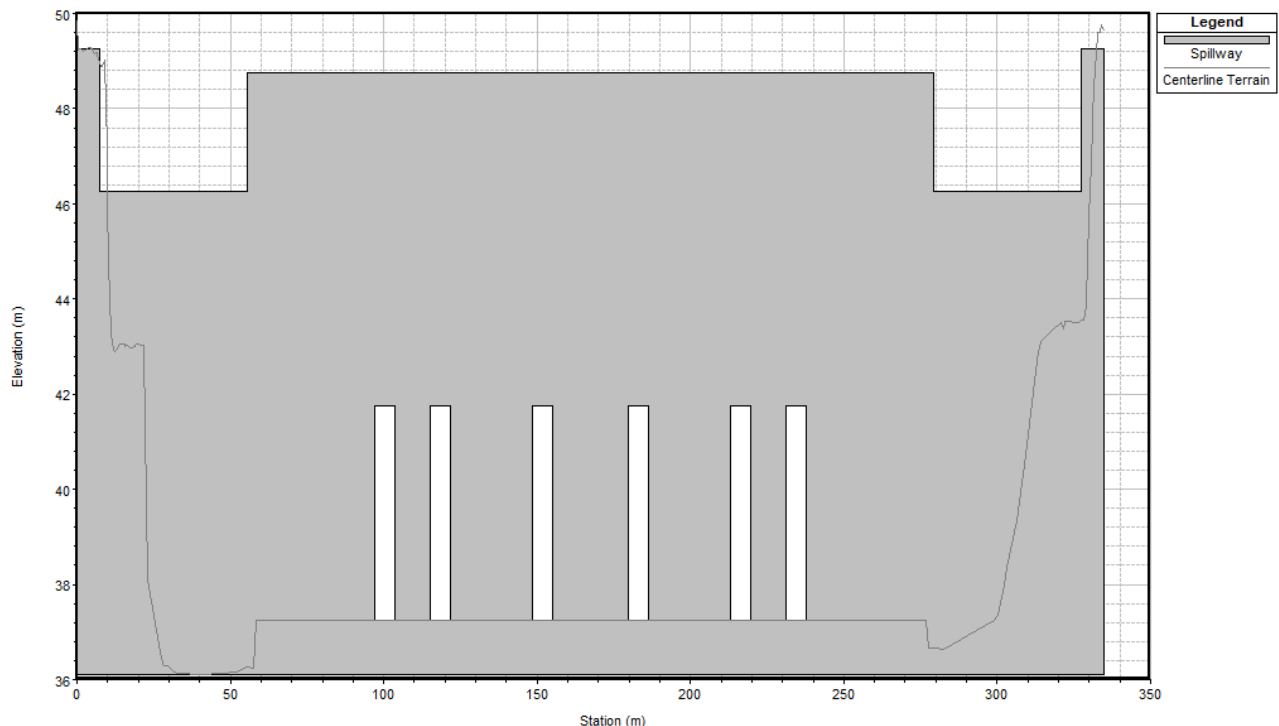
Sezione longitudinale schematica del manufatto principale di progetto.
